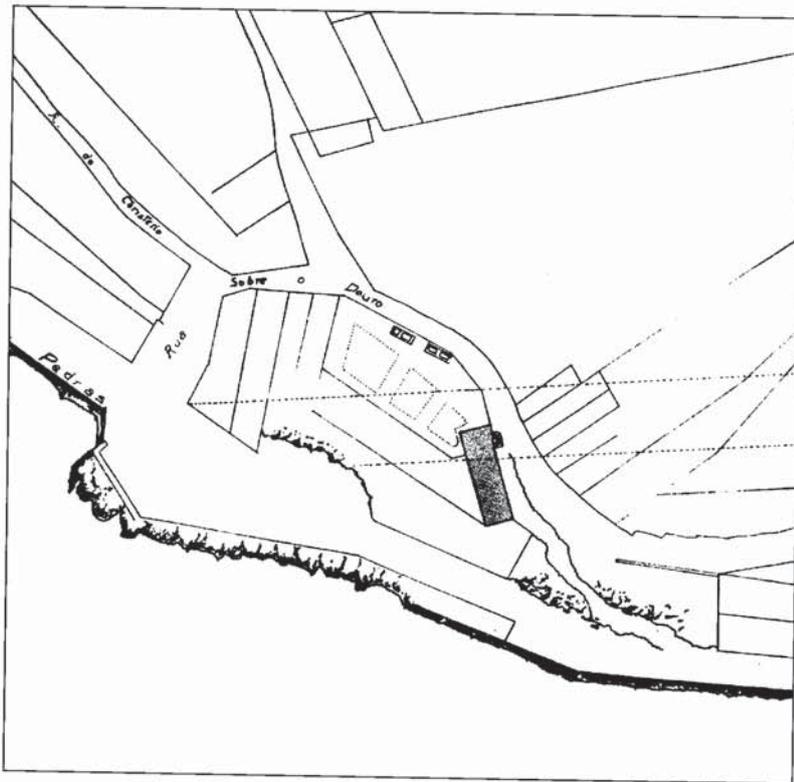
Fábrica de Massarelos, segundo a planta de 1826 (Esc. apr. 1:500)
